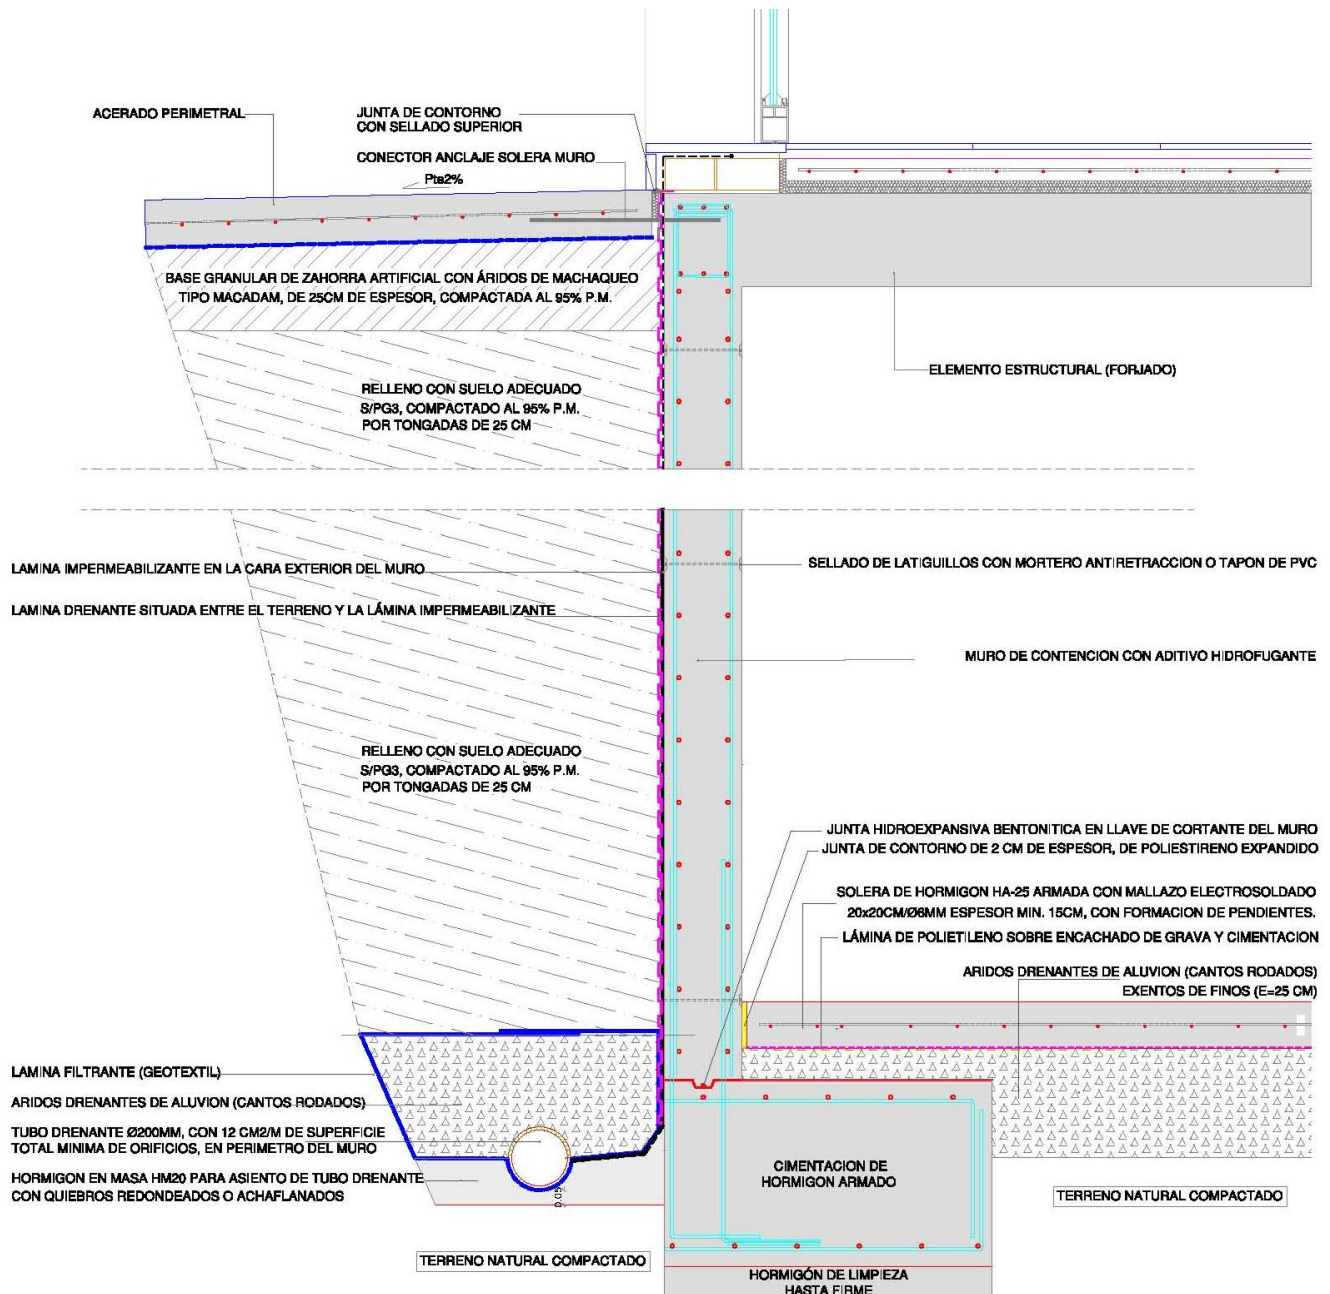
Esquema orientativo sobre la impermeabilización, protección y drenaje de muro de sótano. Sin presencia de N.F.
